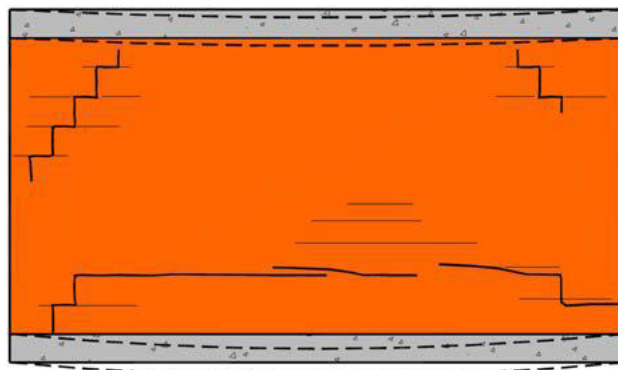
Fissuração devido à deformação do suporte superior em relação ao elemento superior [14], adaptado de Lucas Carvalho, 1990
